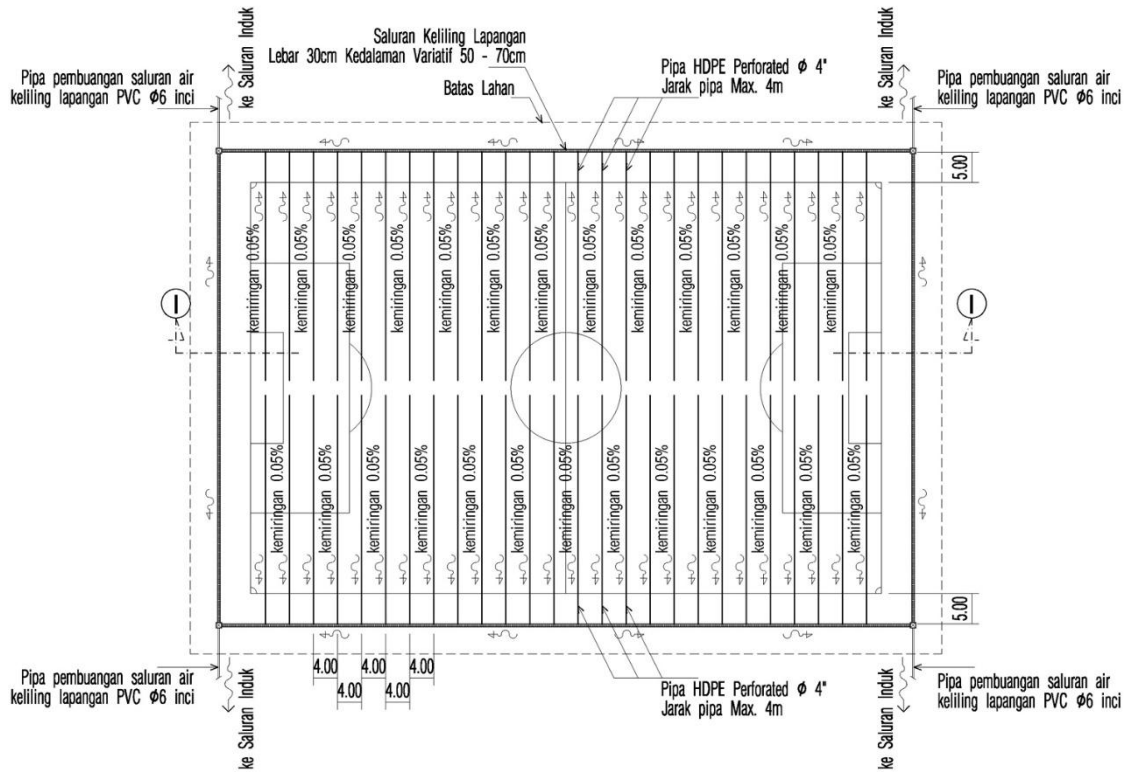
Denah dan ukuran lapangan sepakbola.
